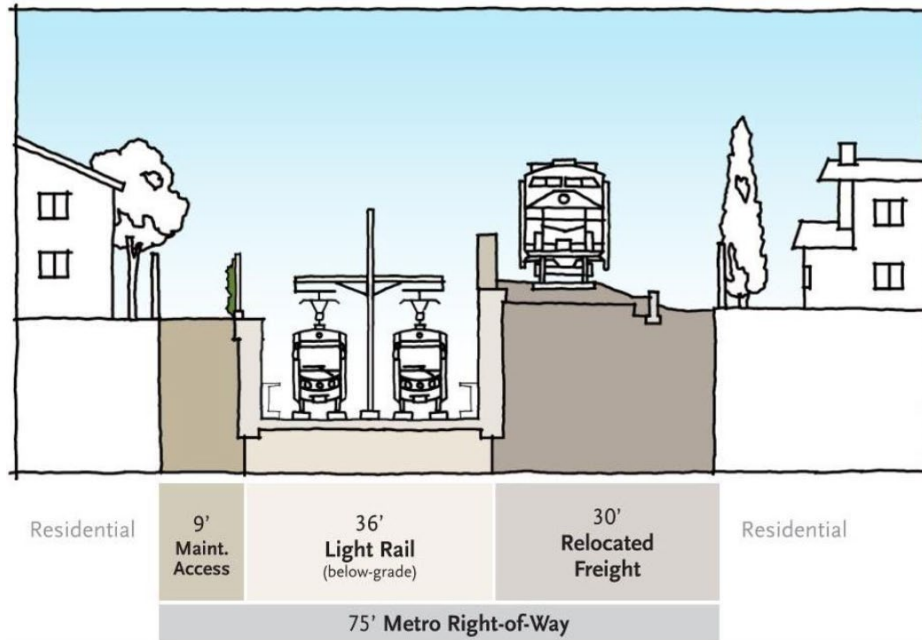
Alternativa preferida a nivel local: Hacia el sur entre 165th Street y 168th Street
